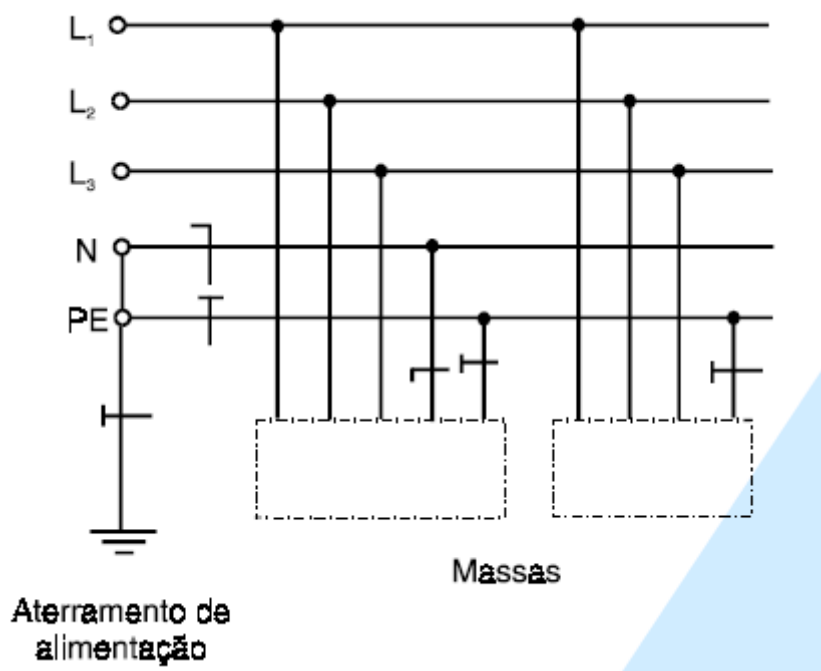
Esquema de ligação para sistema de aterramento da instalação de baixa tensão da Creche. (NBR 5410) – Onde o condutor de neutro e de proteção são separados ao longo da instalação TN-S.
